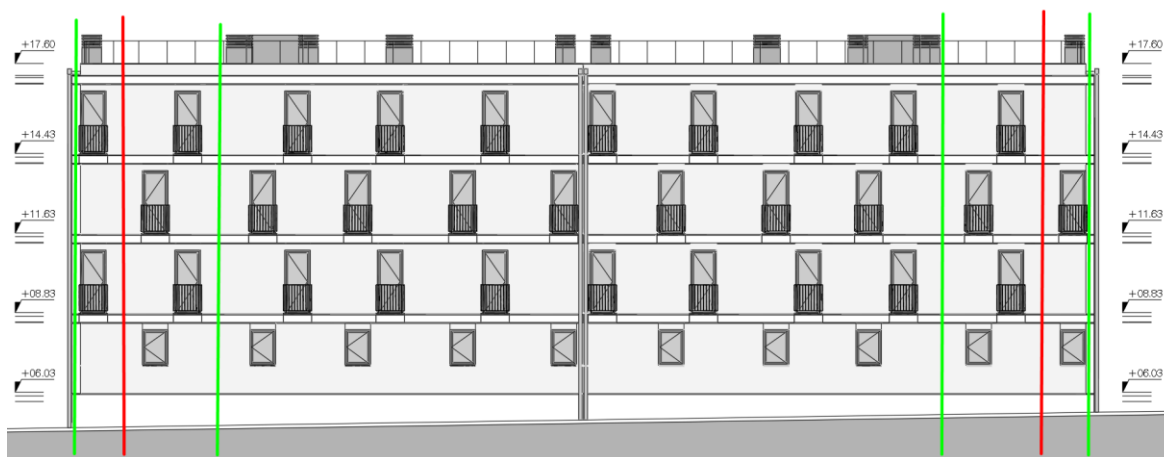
Alçado da fachada de tardoz. Identificação dos alinhamentos dos pilares.
